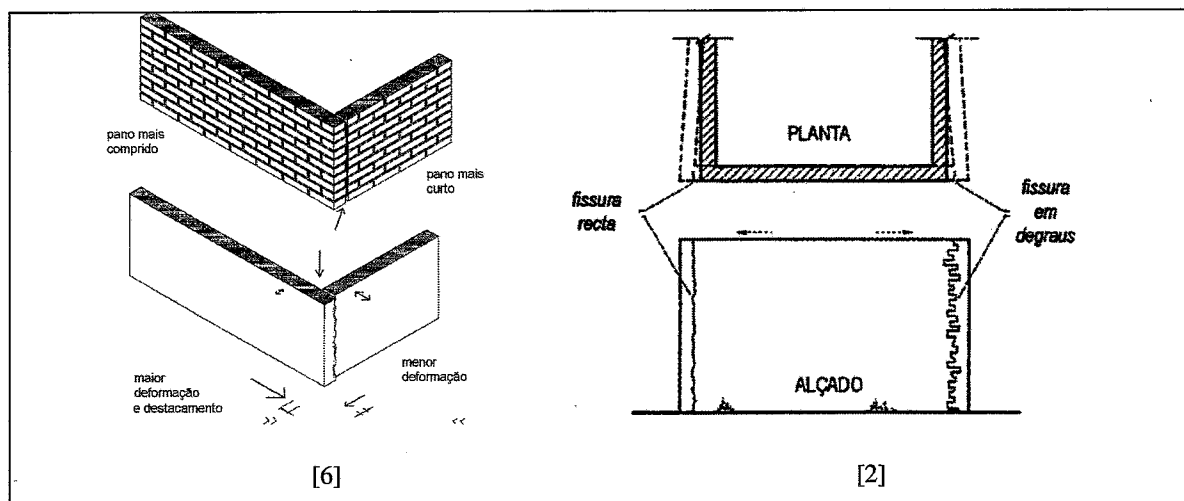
Fissuração e arrastamento dos panos mais curtos em cunhais
